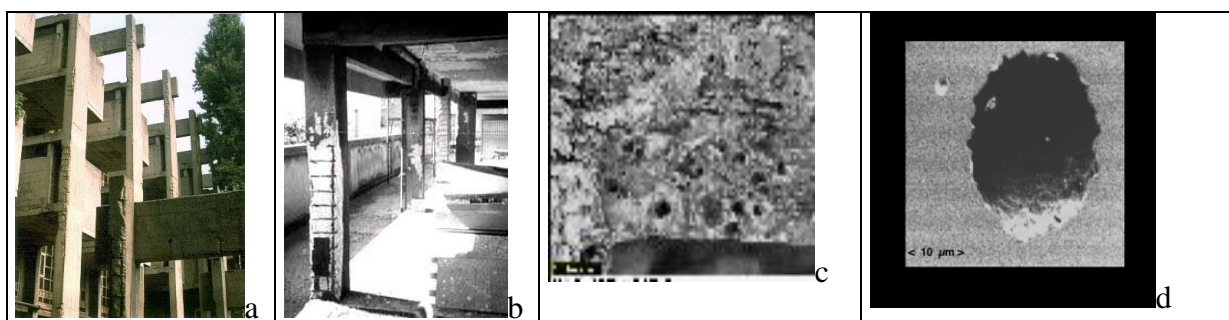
a,b Esempi di deterioramento di strutture di calcestruzzo armato; c Pitting su un acciaio inossidabile della serie 300; d Immagine SEM di un pit sullo stesso acciaio
